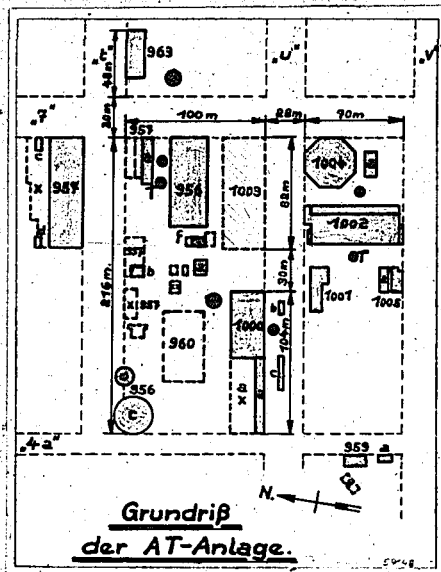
Grundriss der AT-Anlage Leuna.
